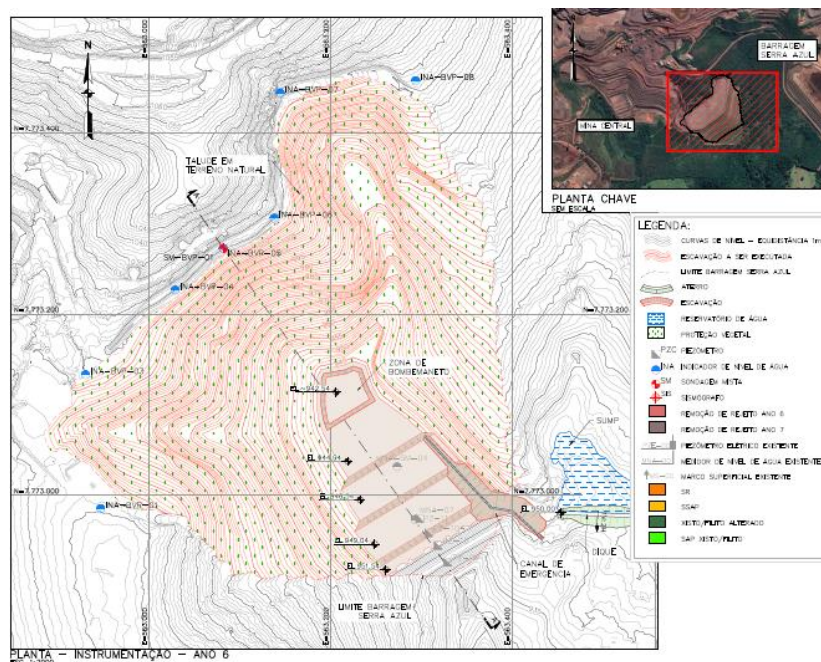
Projeto BVP – Descaracterização Elevação (instrumentação).
